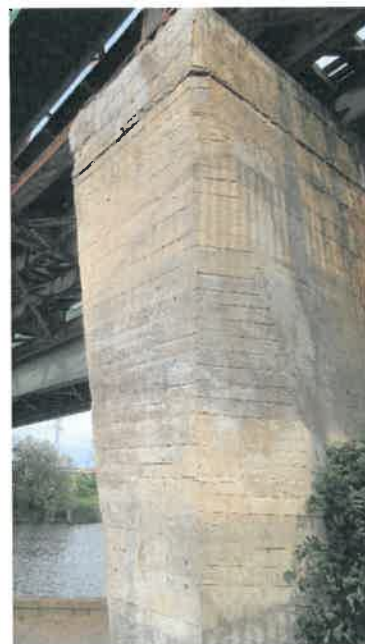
Widok od strony Braniewa. Graffiti obniżające estetykę. Spękania otuliny betonowej. Osady na betonie, białe przebarwienia betonu.
